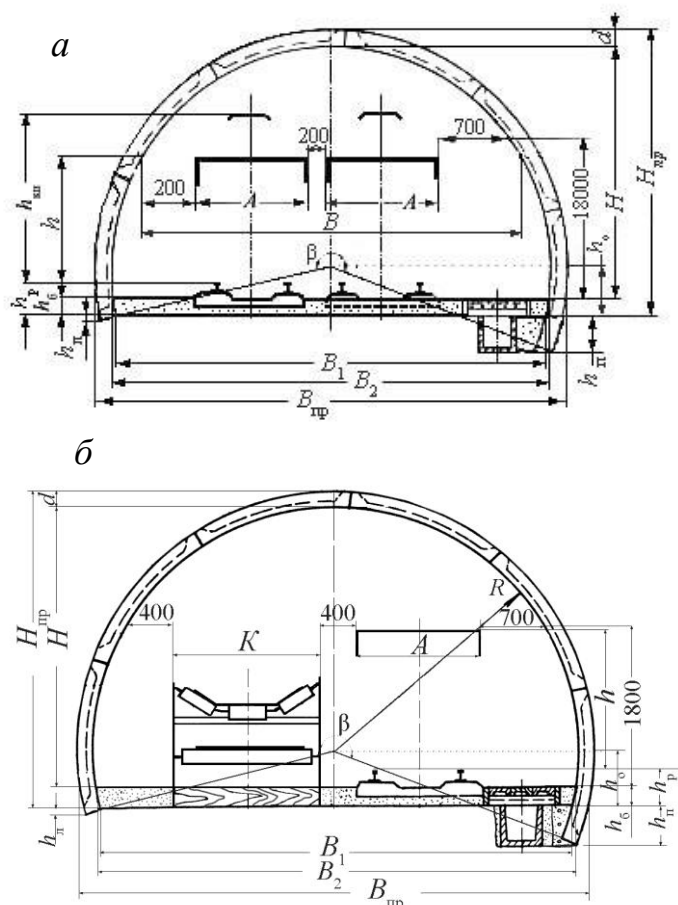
Поперечные сечения выработок с крепью ГТК:
